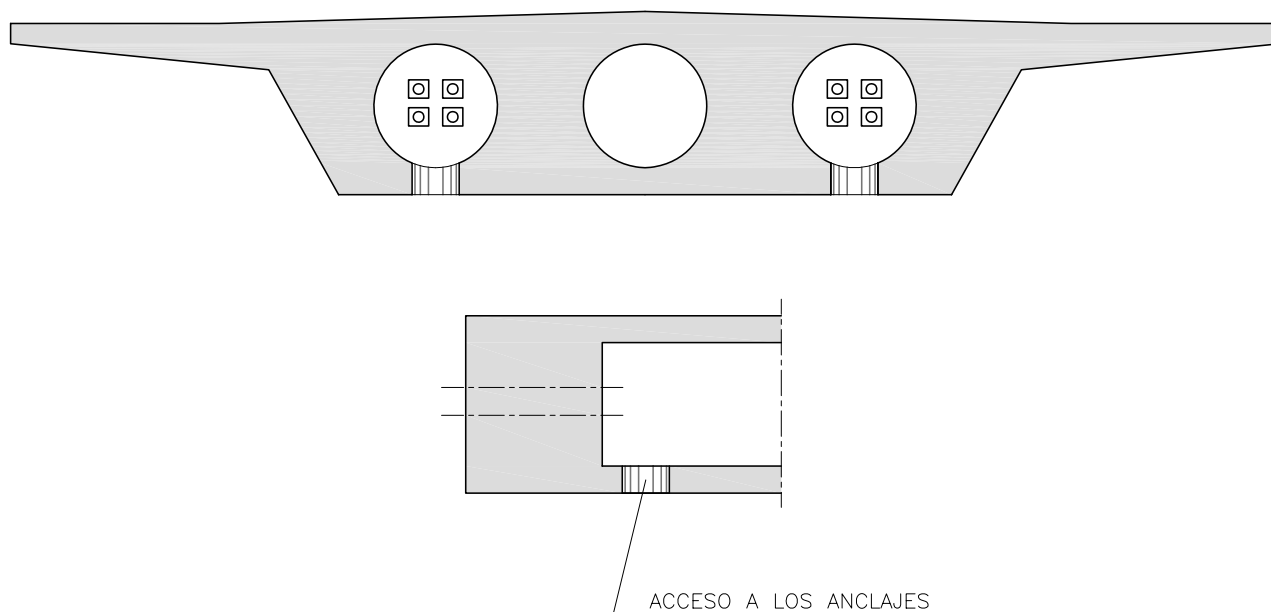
Estribo fijo de tablero tipo losa pretensada. Cajetín de acceso a anclajes
